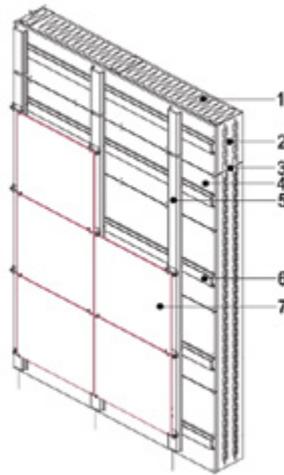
Каркасно-обшивная стена (КОС): 1 – основной теплоизоляционный слой (между стойками каркаса), 2 – стойки каркаса стены, 3 – стык модульной конструкции КОС, 4 – наружная обшивка КОС, 5 – стальные профили обрешетки (вертикальные), 6 – стальные профили обрешетки (горизонтальные), 7 – облицовка (фасадная отделка).
